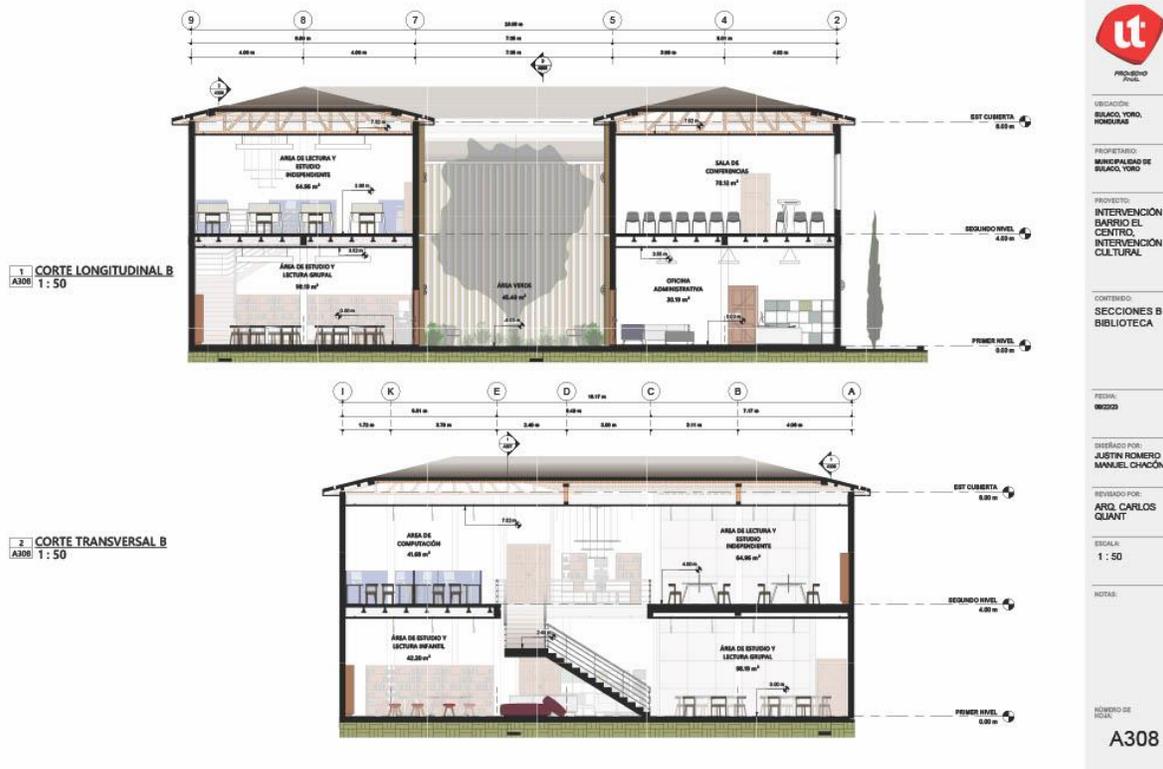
Secciones Secundarias | Fuente: elaboración Propia
